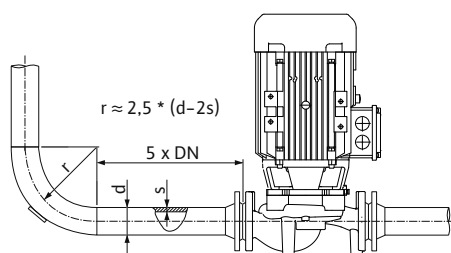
Percorso di stabilizzazione a monte e a valle della pompa
